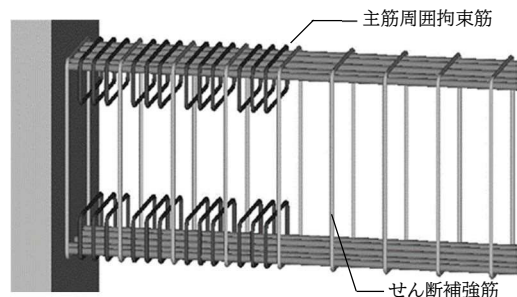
主筋周囲拘束筋を配置した RC 梁の概要
